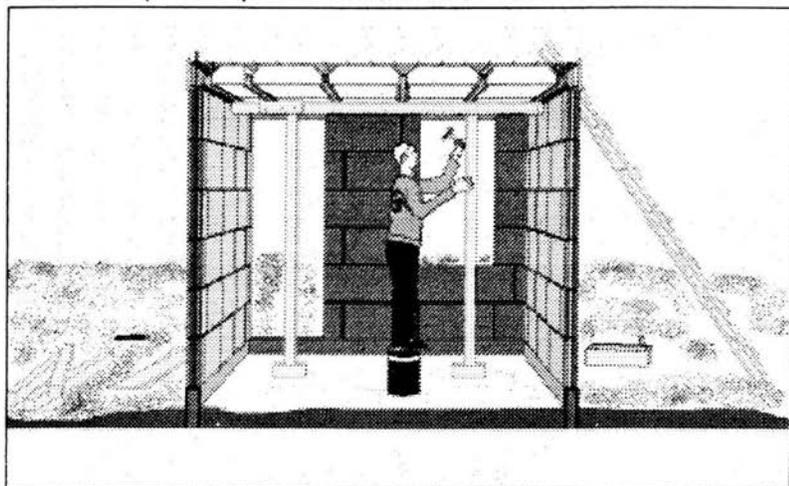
En la figura se muestra en forma esquemática la colocación de cimbra en el sistema constructivo de vigueta y bovedilla.
